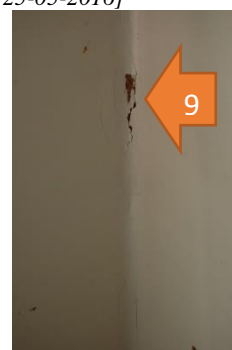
Fissuração do reboco com a cortiça à vista, no Piso 1 [Fonte: Autora, Data: 30-05-2016]
